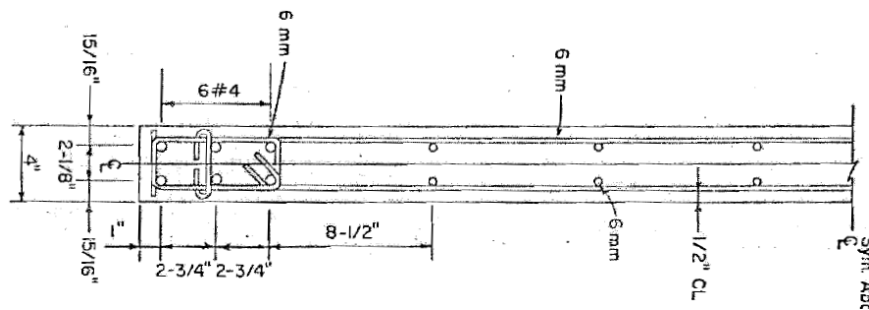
Detallado y refuerzo del espécimen R2 (Oesterle et al., 1976).
